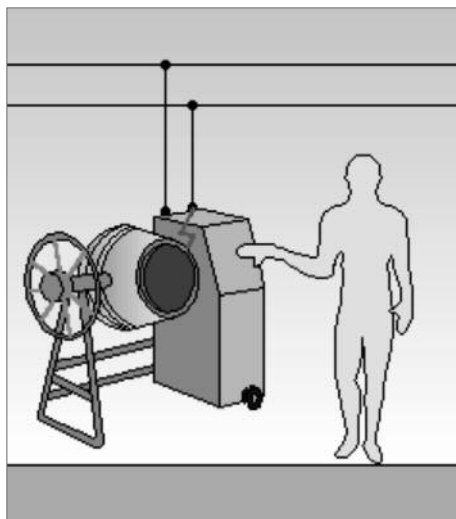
Contatto indiretto: la carcassa della betoniera (massa) assume una tensione pericolosa a causa del cedimento dell'isolamento di una parte attiva al suo interno
